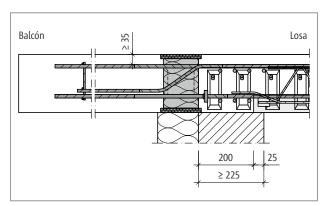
Schöck Isokorb® XT tipo C: Placa prefabricada sin apoyo periférico con SATE (sección XT tipo C-L-CV35, vista XT tipo C-R-CV50)
